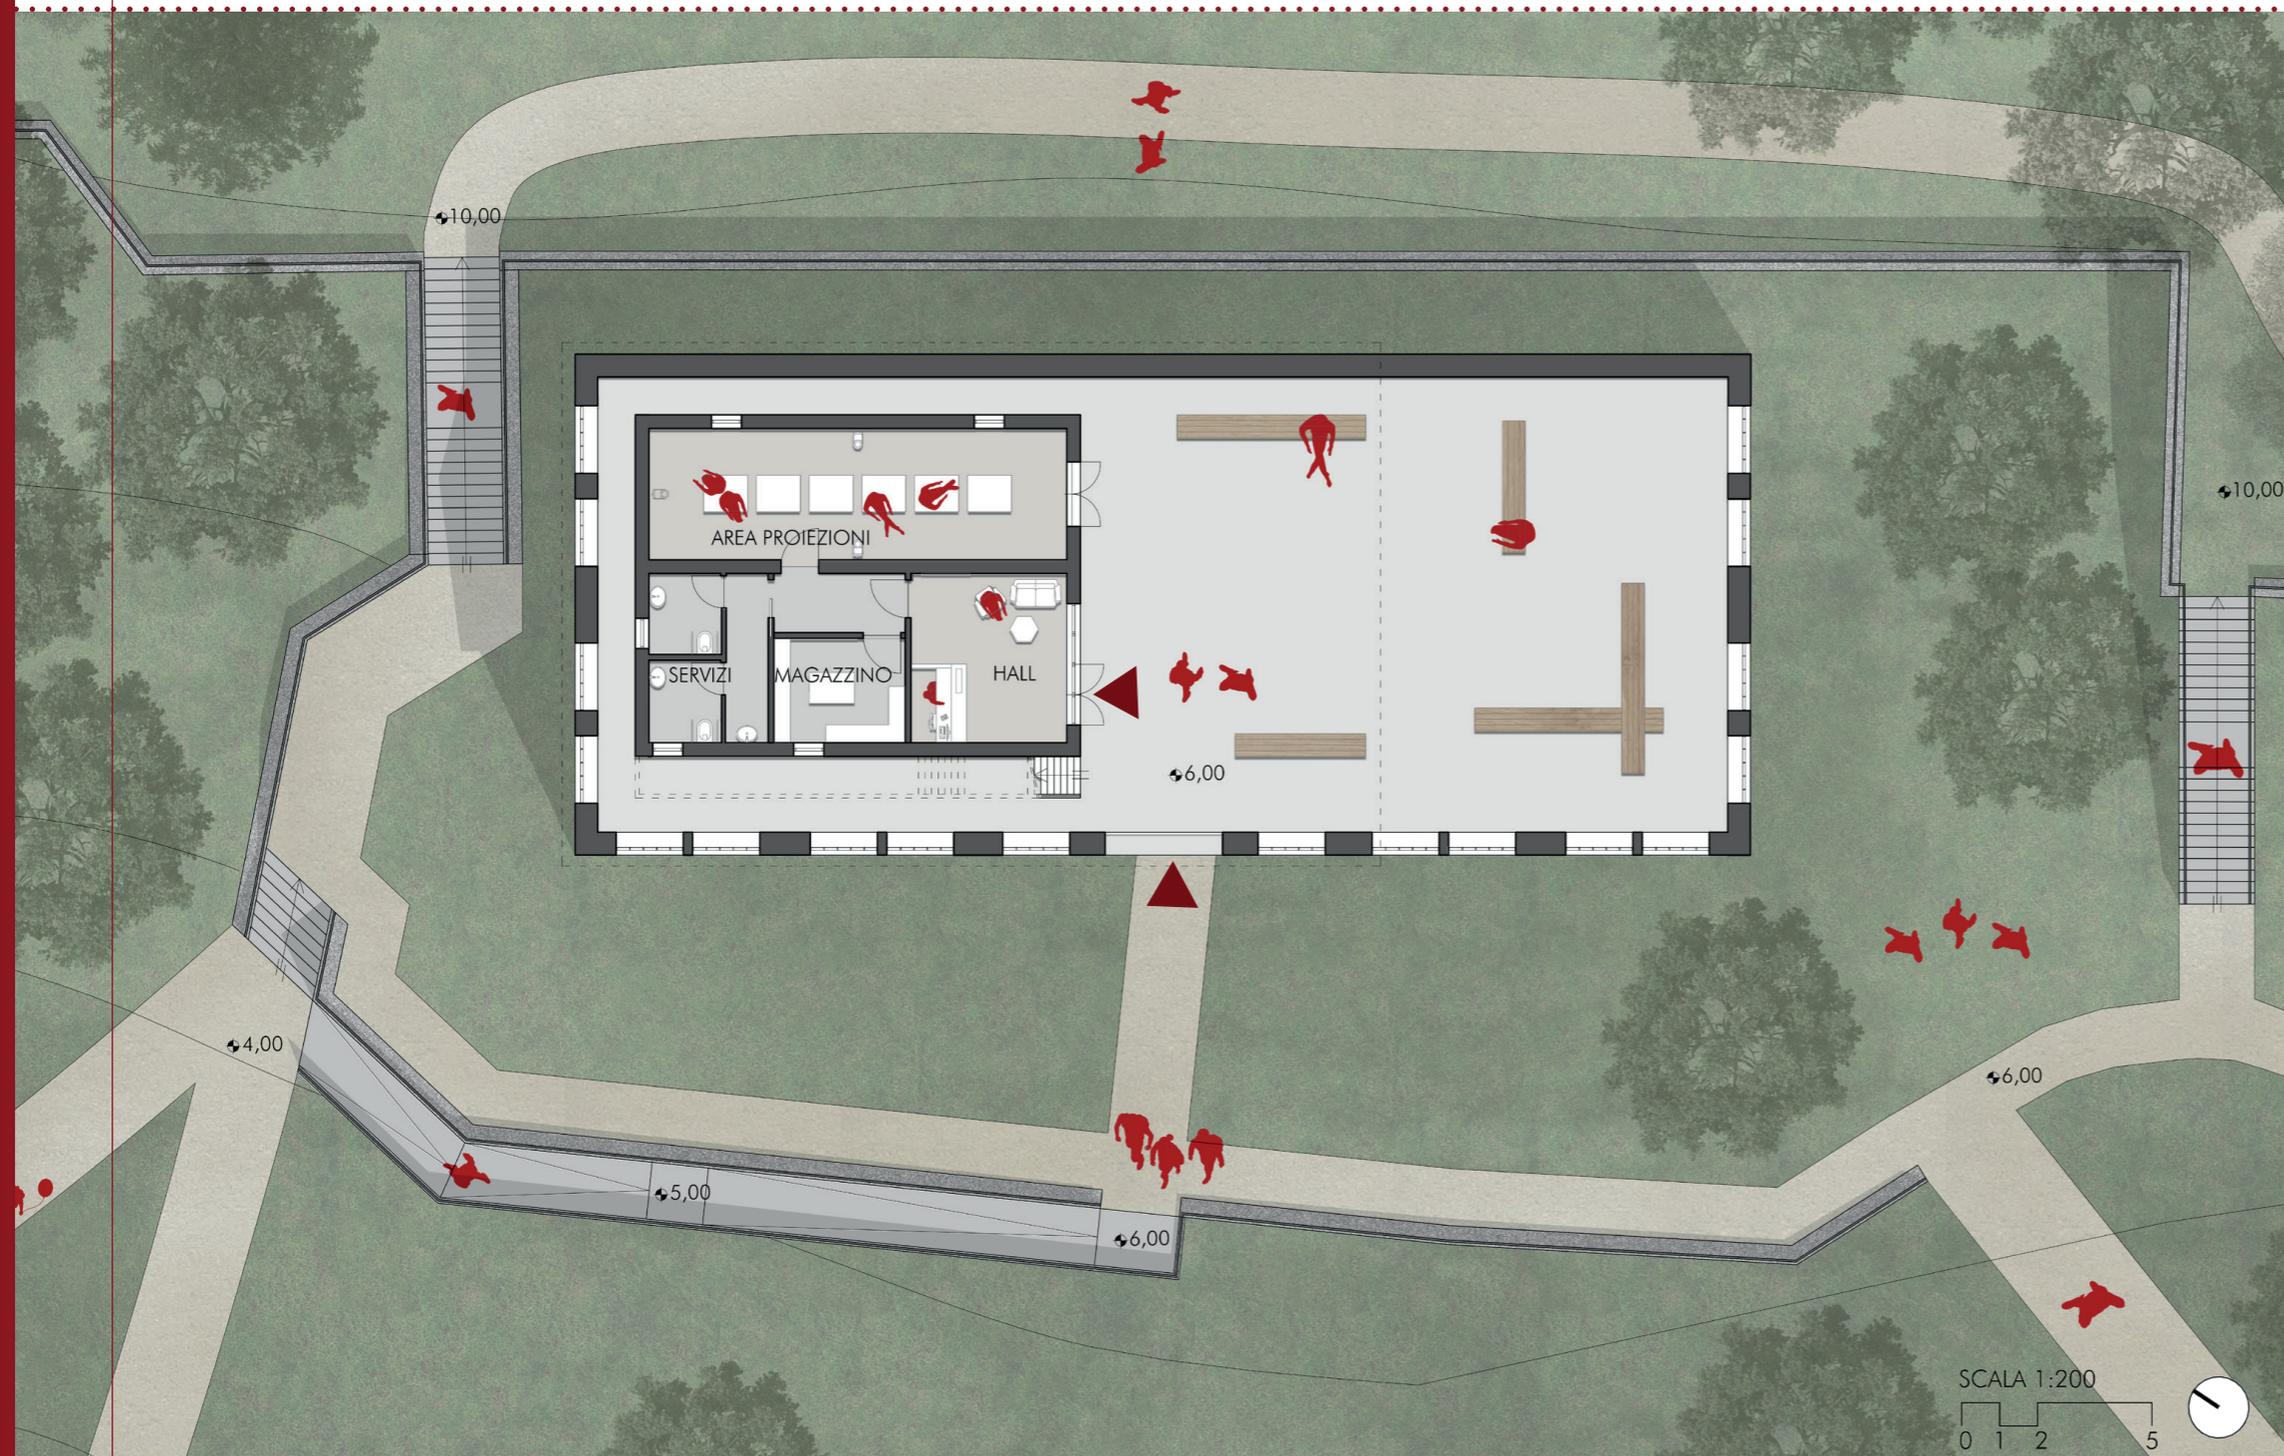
Pianta del piano terra del polo centrale dell'escape room, elaborazione delle autrici
